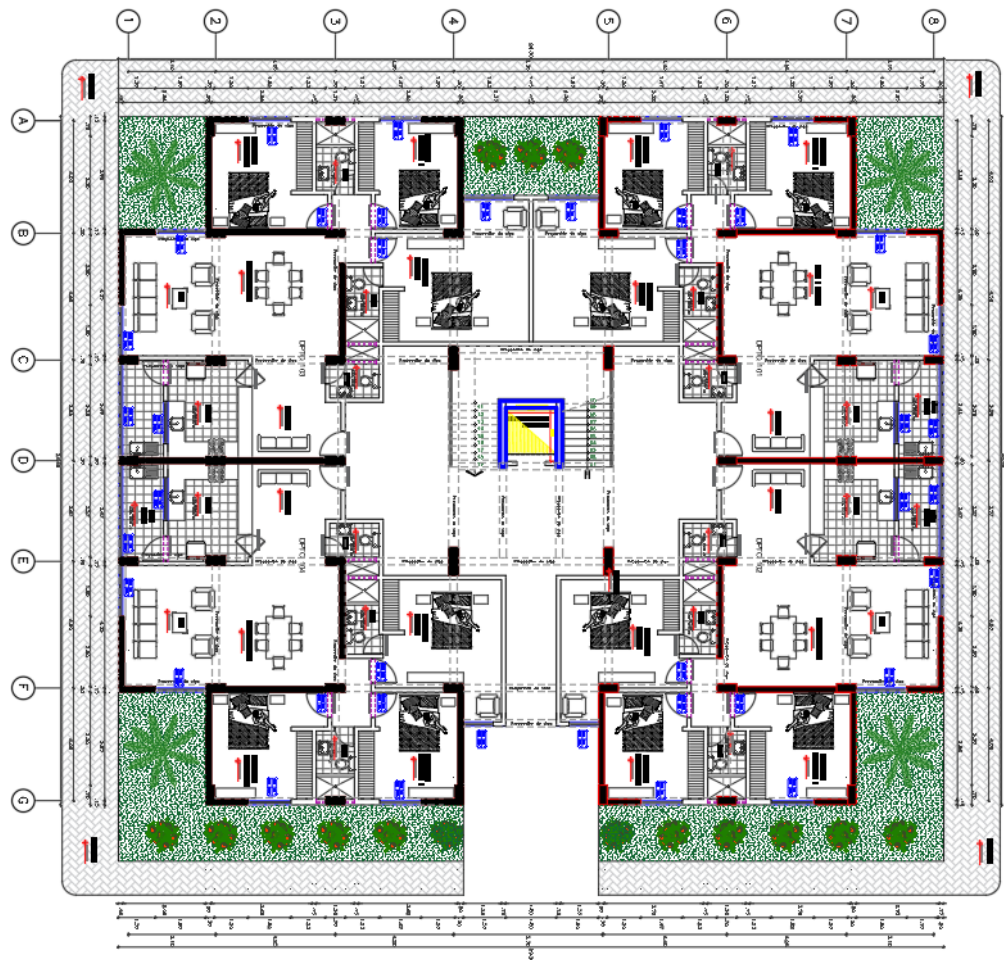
Vista en planta de la arquitectura del edificio – piso 1
